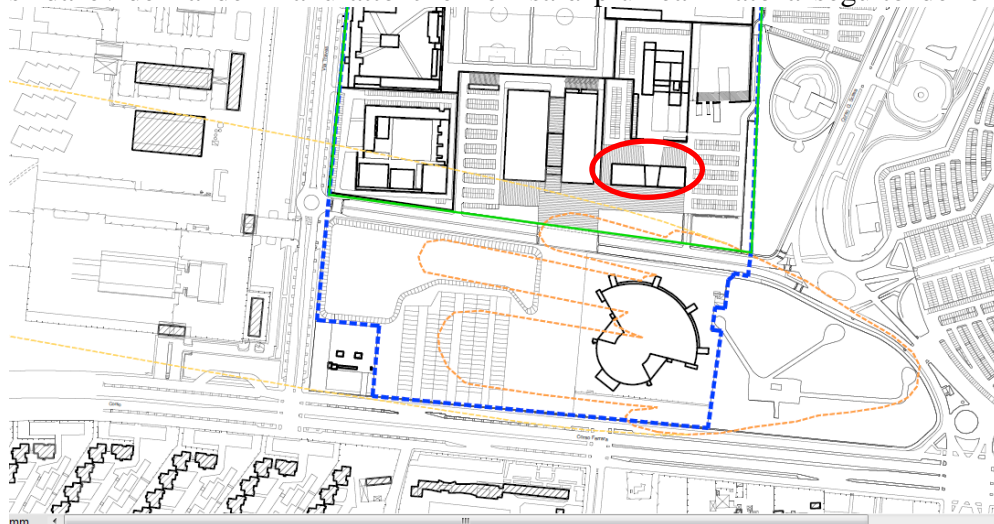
PEC Luglio 2014 con sovrapposizione delle zone di rispetto. Cerchiato in rosso il manufatto che non sarà più realizzato a seguito delle modifiche di PEC proposte
